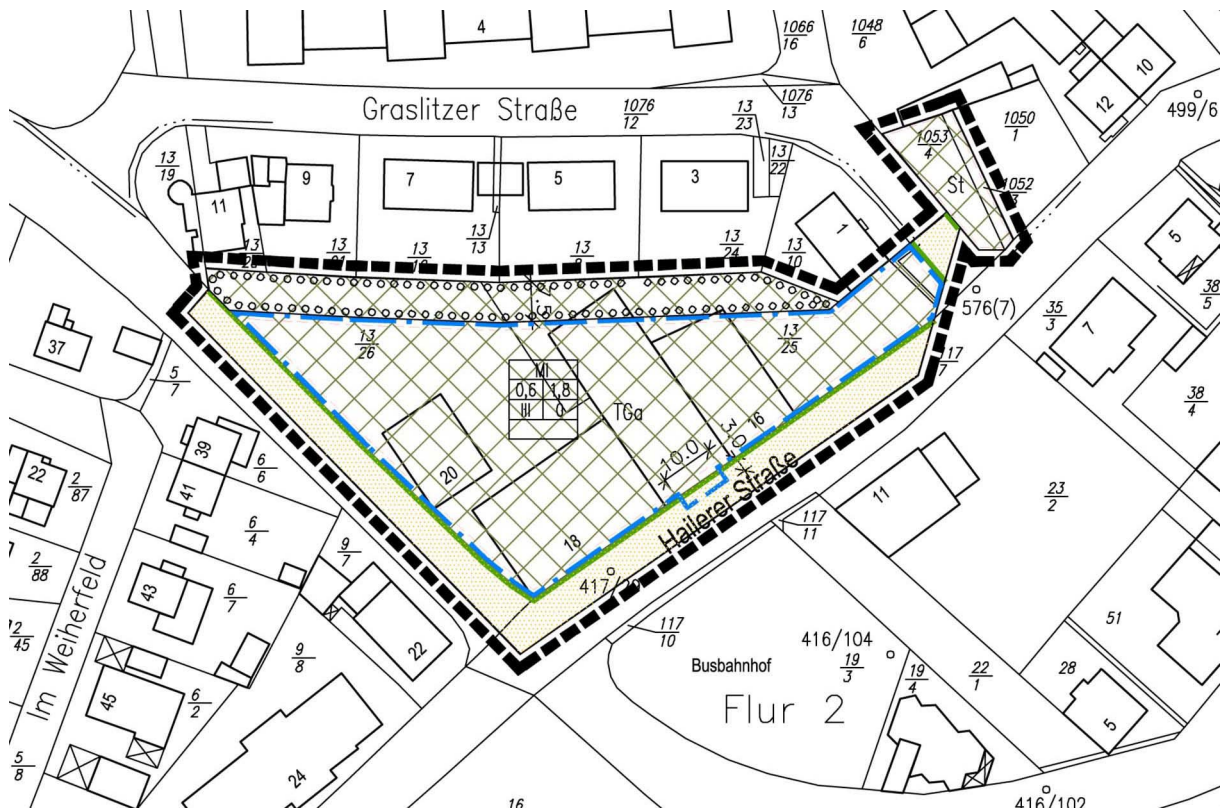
Bebauungsplan „Ziegelhaus Teilplan A“
